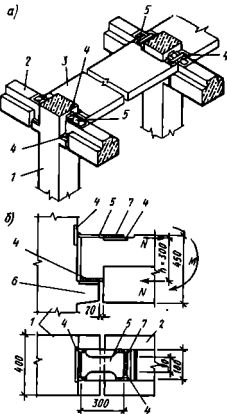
Узел опирания ригеля на колонну в унифицированном каркасе:
